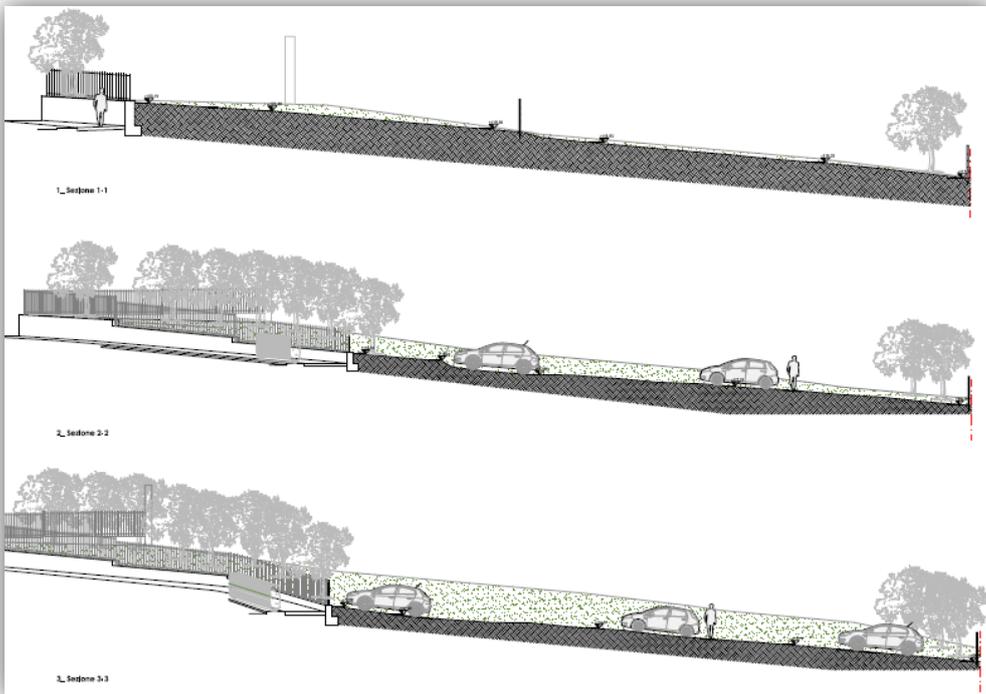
Sezioni stato di progetto (Tav. 03 - Progetto definitivo)
